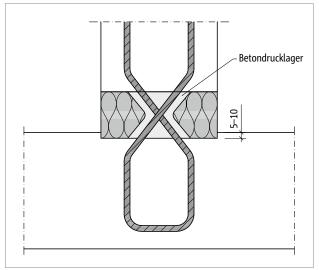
Schöck Sconnex® Typ W: Detail 1; Formschluss durch 5–10 mm tiefe Einsenkung des Dämmkörpers in die Decke
